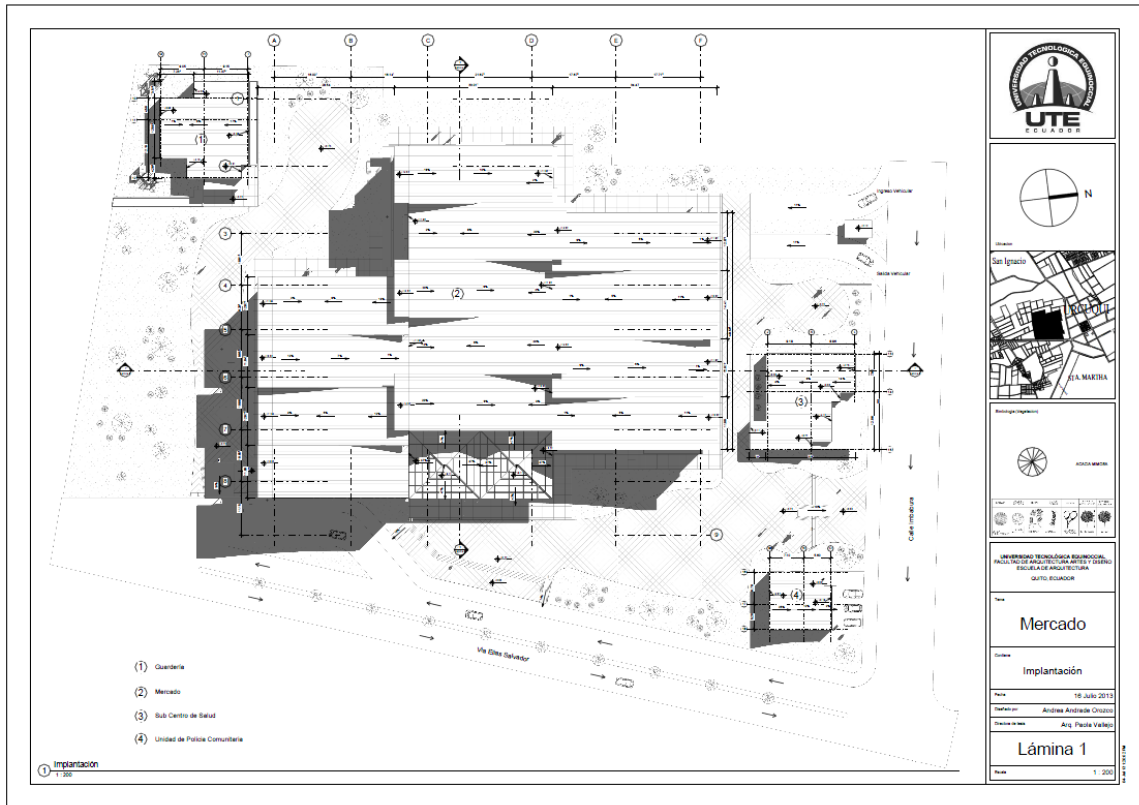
; IMPLANTACIÓN; Fuente: Andrea Andrade Orozco
